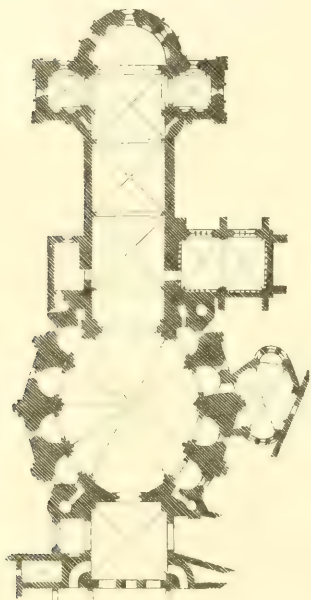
S. Gereon zu Köln. Grundriss.
